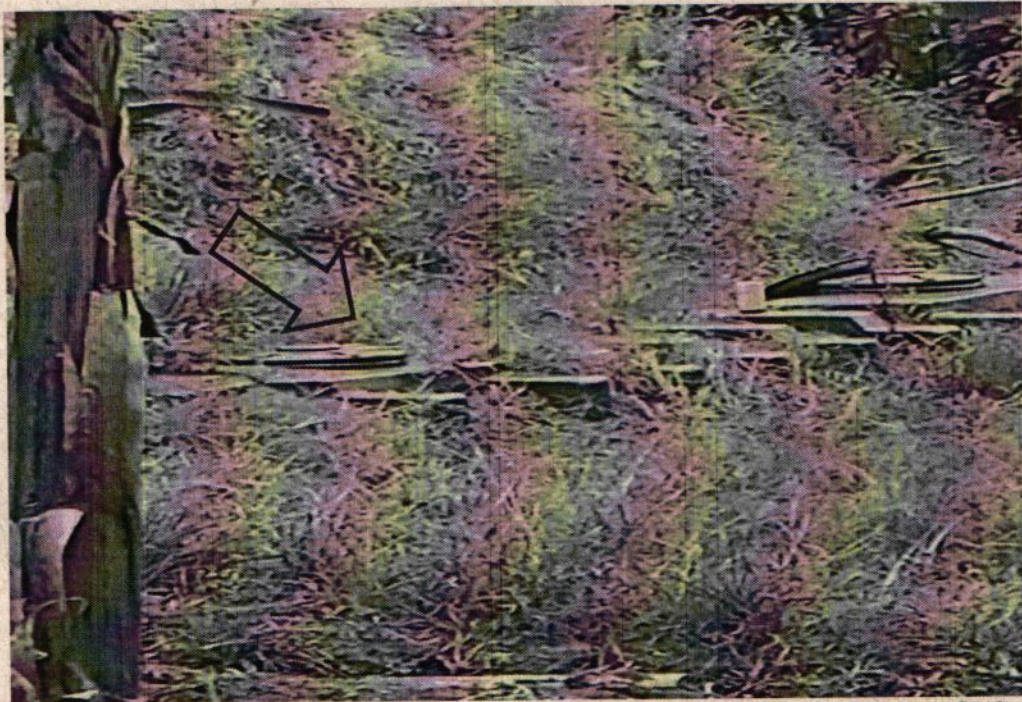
STARD construido en el Lote 1 que cuenta con concepto favorable de la CVC
